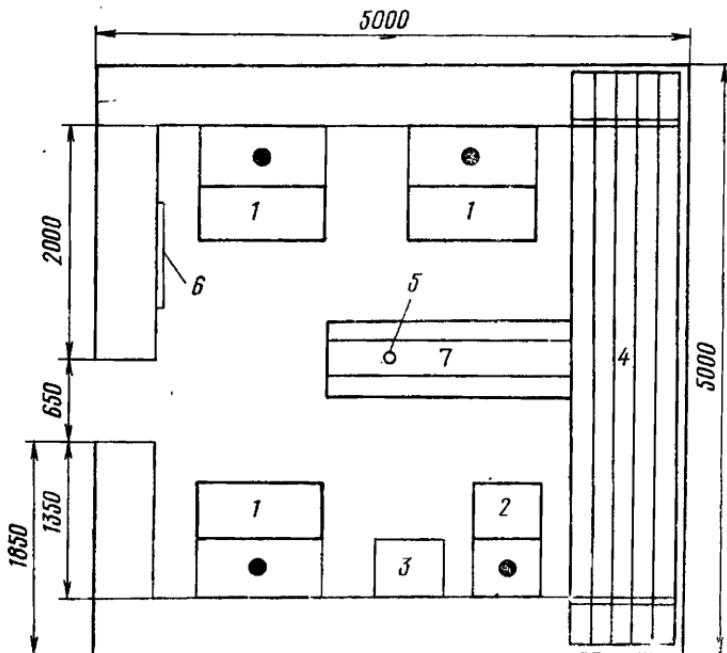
План размещения оборудования мастерской в лагерной палатке:
